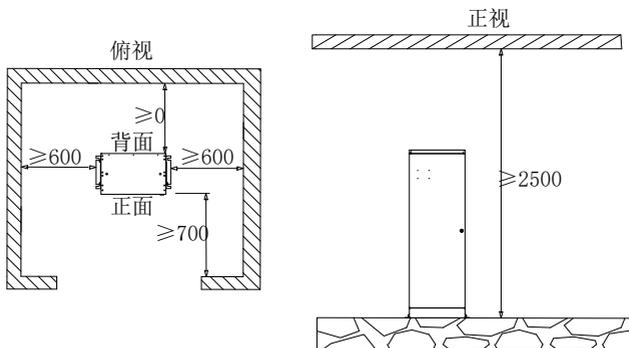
有机房控制柜安装空间要求示意图（单位：mm）
